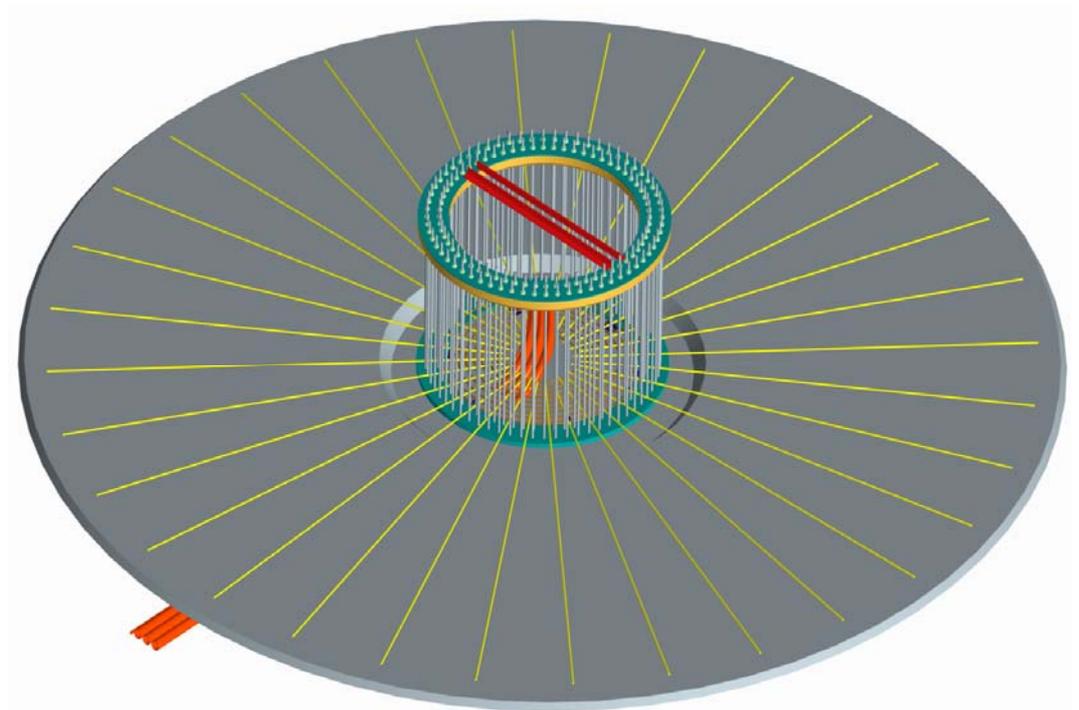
In jedem vierten Zwischenraum ist ein Bewehrungsseisen der unteren Radialbewehrung (Pos. 1.1) installiert.
